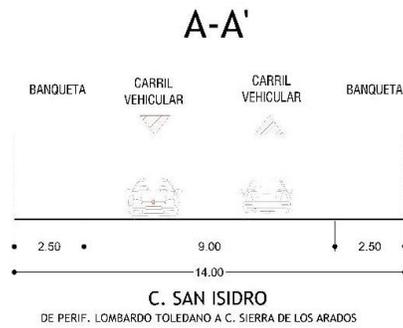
Sección actual e imagen de la C. San Isidro (14.00 m de ancho).
